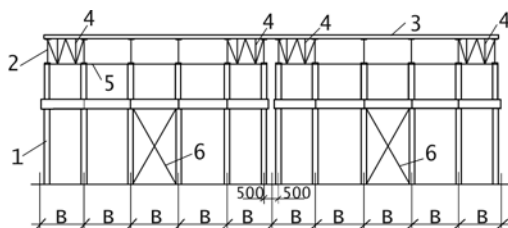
Виды связей в одноэтажных промышленных зданиях: 1 – колонна; 2 – ригель; 3 – диск покрытия; 4 – вертикальные связи–фермы; 5 – распорки; 6 – вертикальные связи по колоннам
